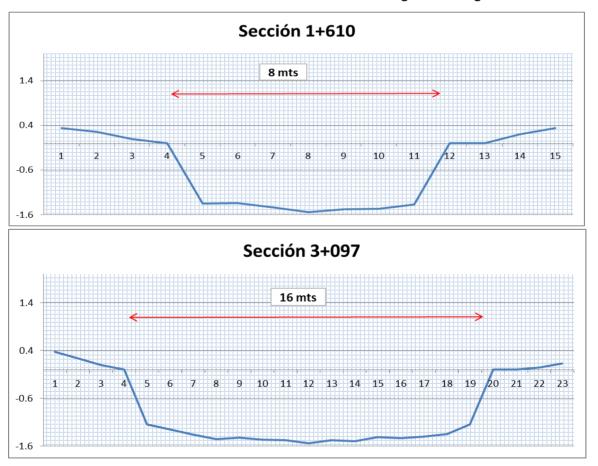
Corte transversal de las secciónes analizadas hidráulicamente en el banco arroyo Ramos
